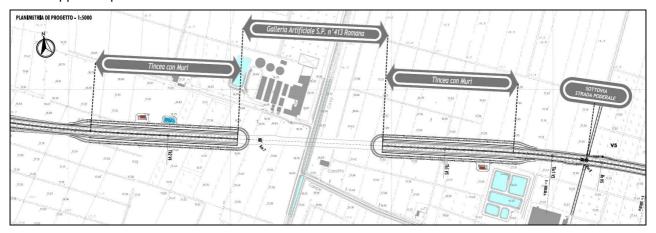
STRALCIO PLANIMETRICO
